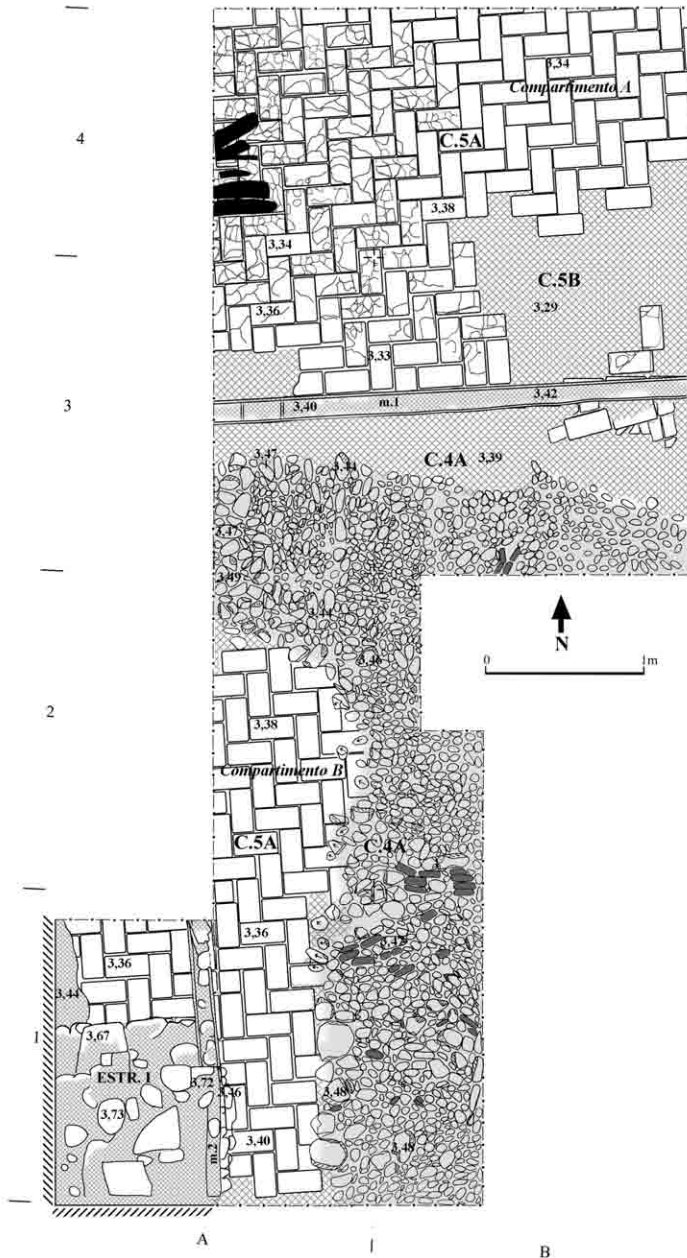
Rua Álvaro Castelões, 38 e 40. Planta com os pavimentos e caixa de escada (Estr. I) do edifício do século XVII, que colapsou e sofreu incêndio durante o sismo de 1755, visível na superfície das tijoleiras fissuradas.
